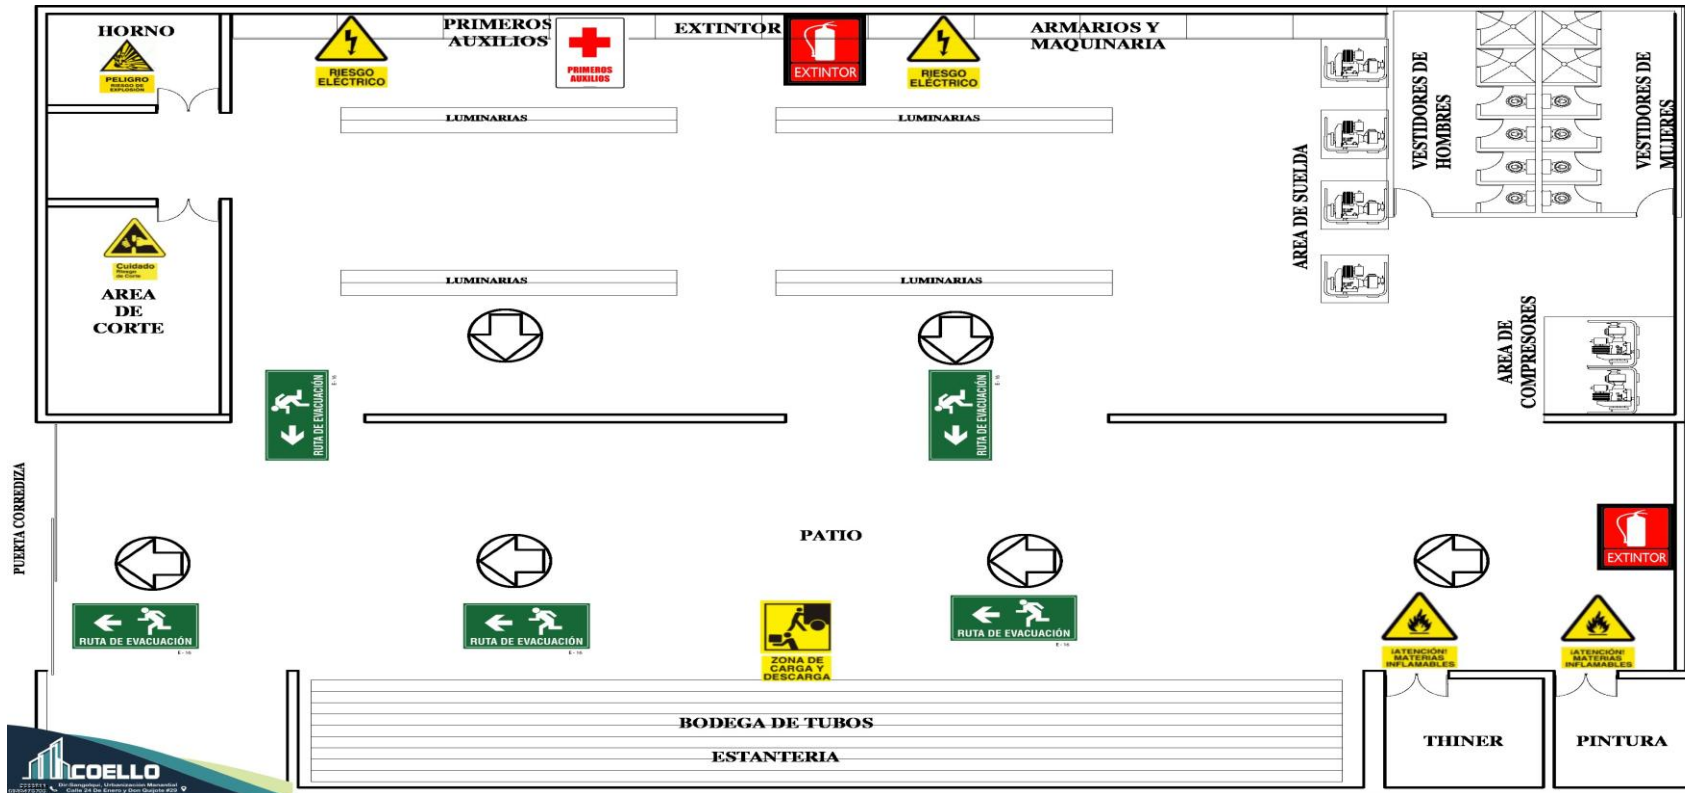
Plano de Seguridad de Estructuras Metálicas Coello
